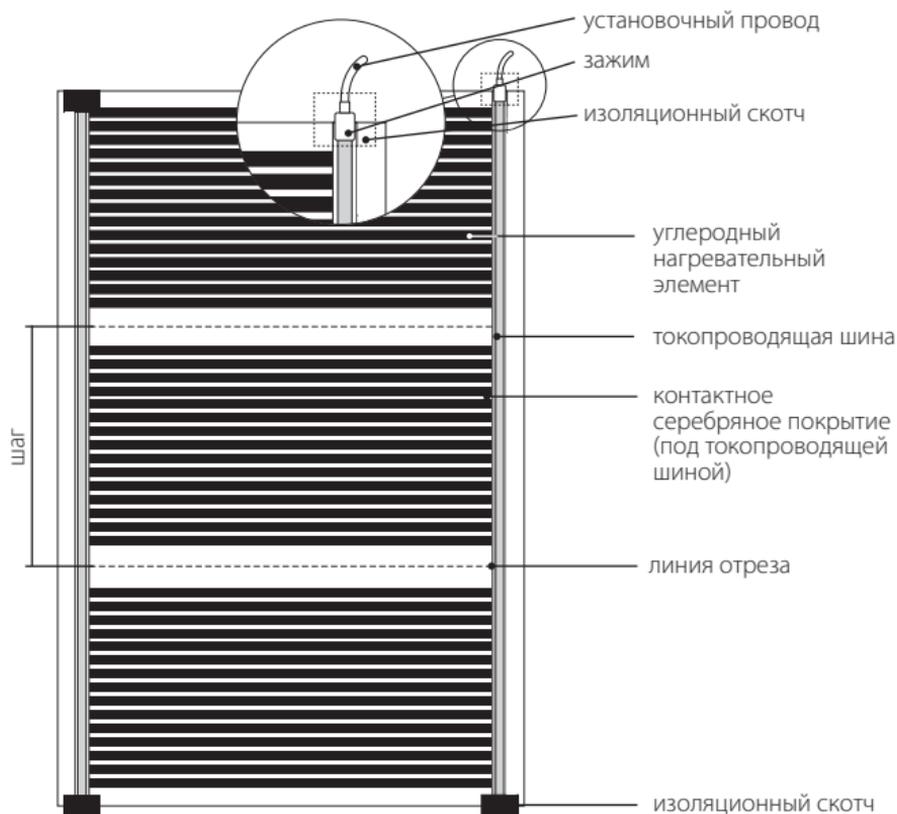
Конструкция нагревательной пленки (вид снизу)
